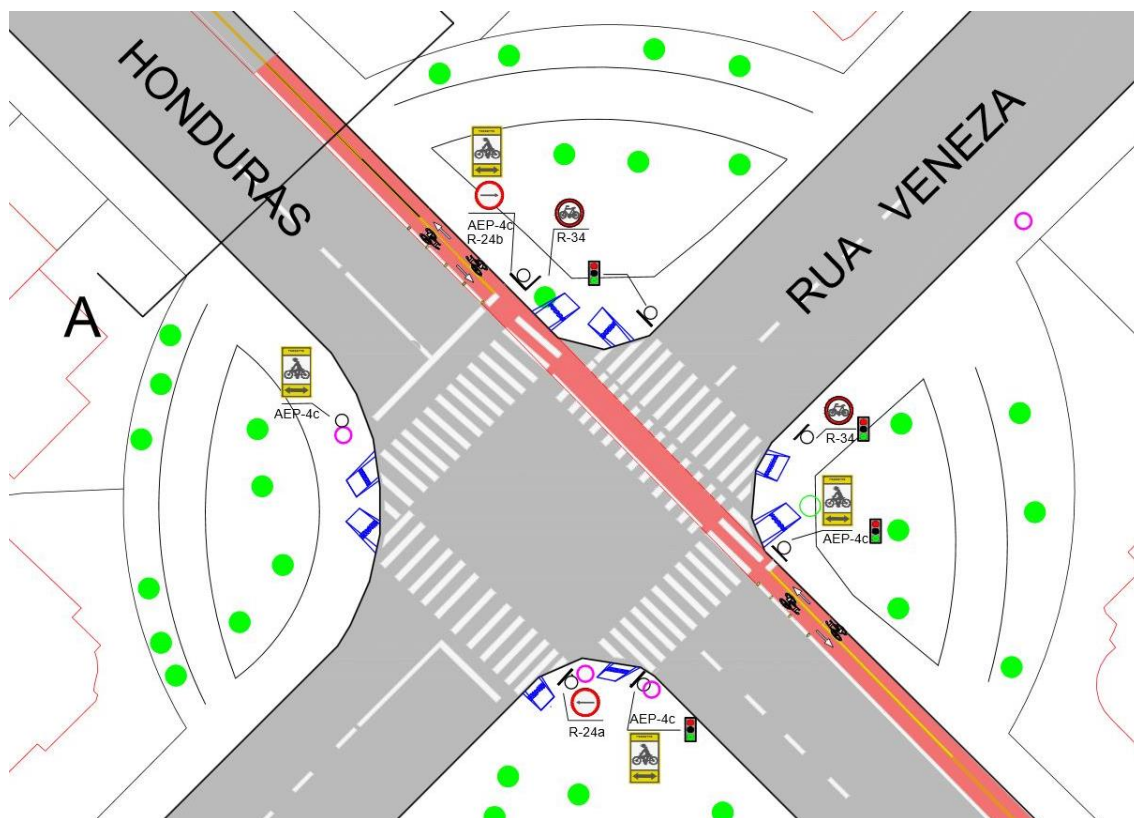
Planta do cruzamento das Ruas Honduras e Veneza (Fonte: Autoria própria).
